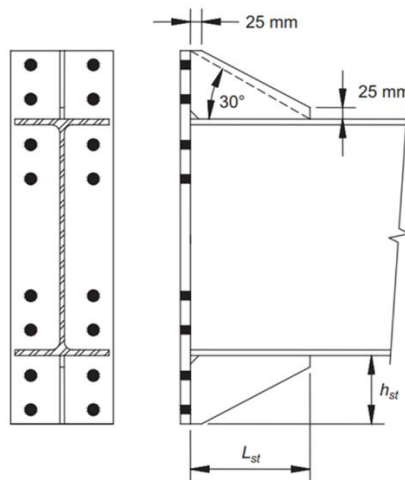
Disposición del rigidizador de placa de extremo y geometría para la 8ES. La geometría para la 4ES es similar.
